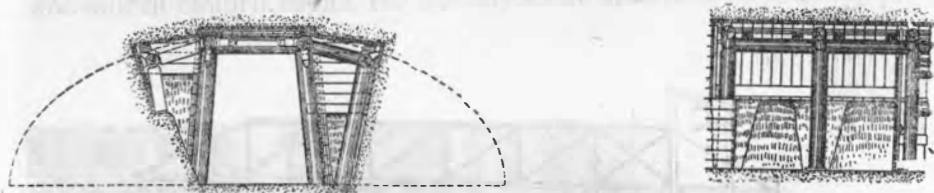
Фаза раскрытия калоттного профиля. Постановка первой пары лонгарины.
